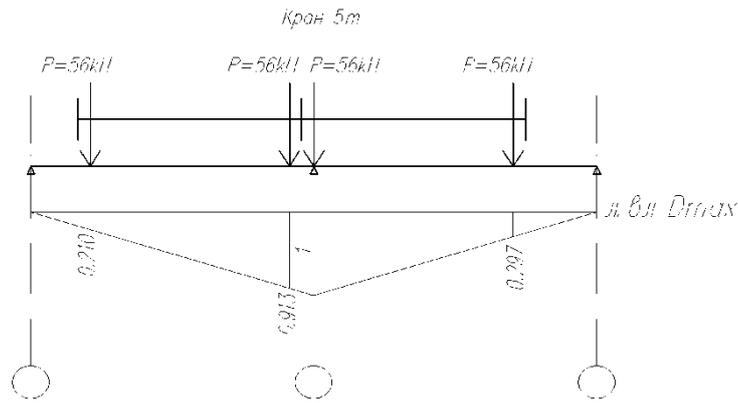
Схема приложения нагрузки от крана 5т
